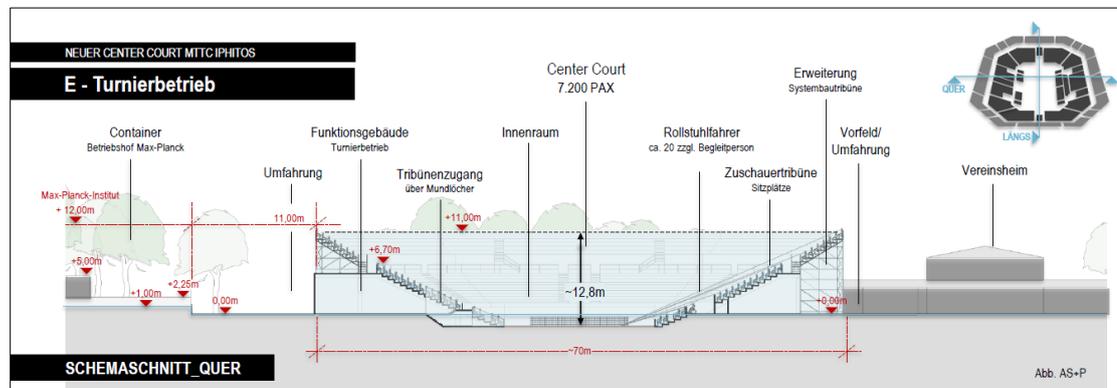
Schemaschnitt quer – Turnierbetrieb
